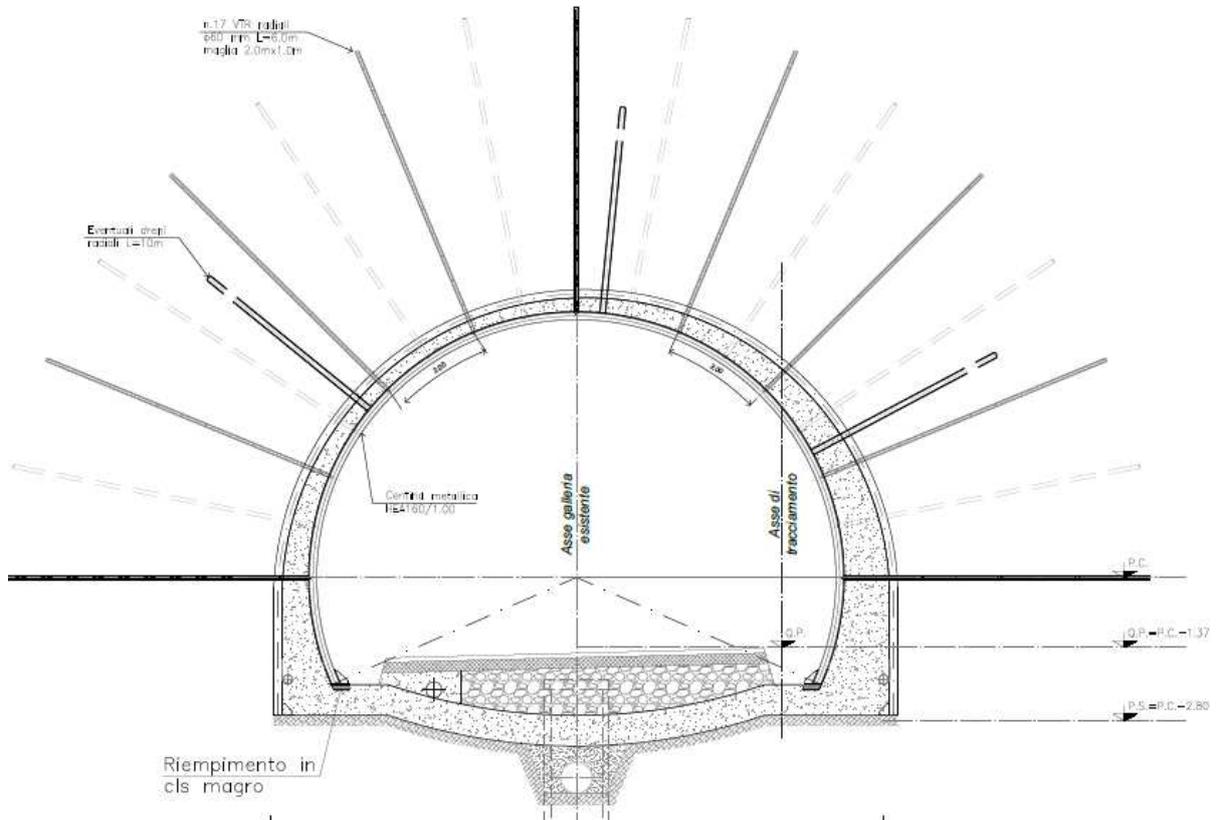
Galleria Guinza – Intervento Tipo A – Sezione corrente – Scavo – Sez. 1
